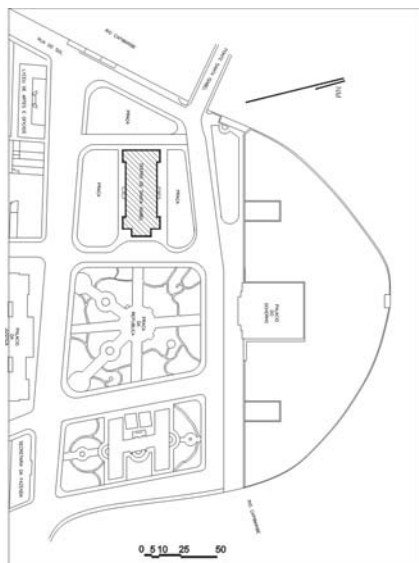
Atual Implantação do Teatro Santa Isabel na Praça da República
